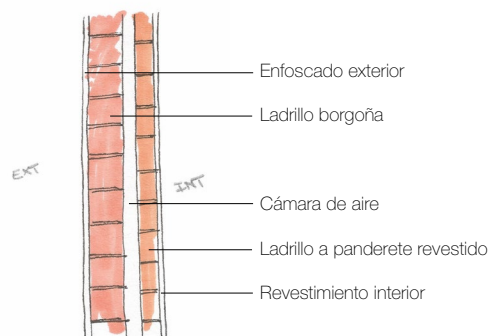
Sección de pared en balcón y terraza (autoría propia).
